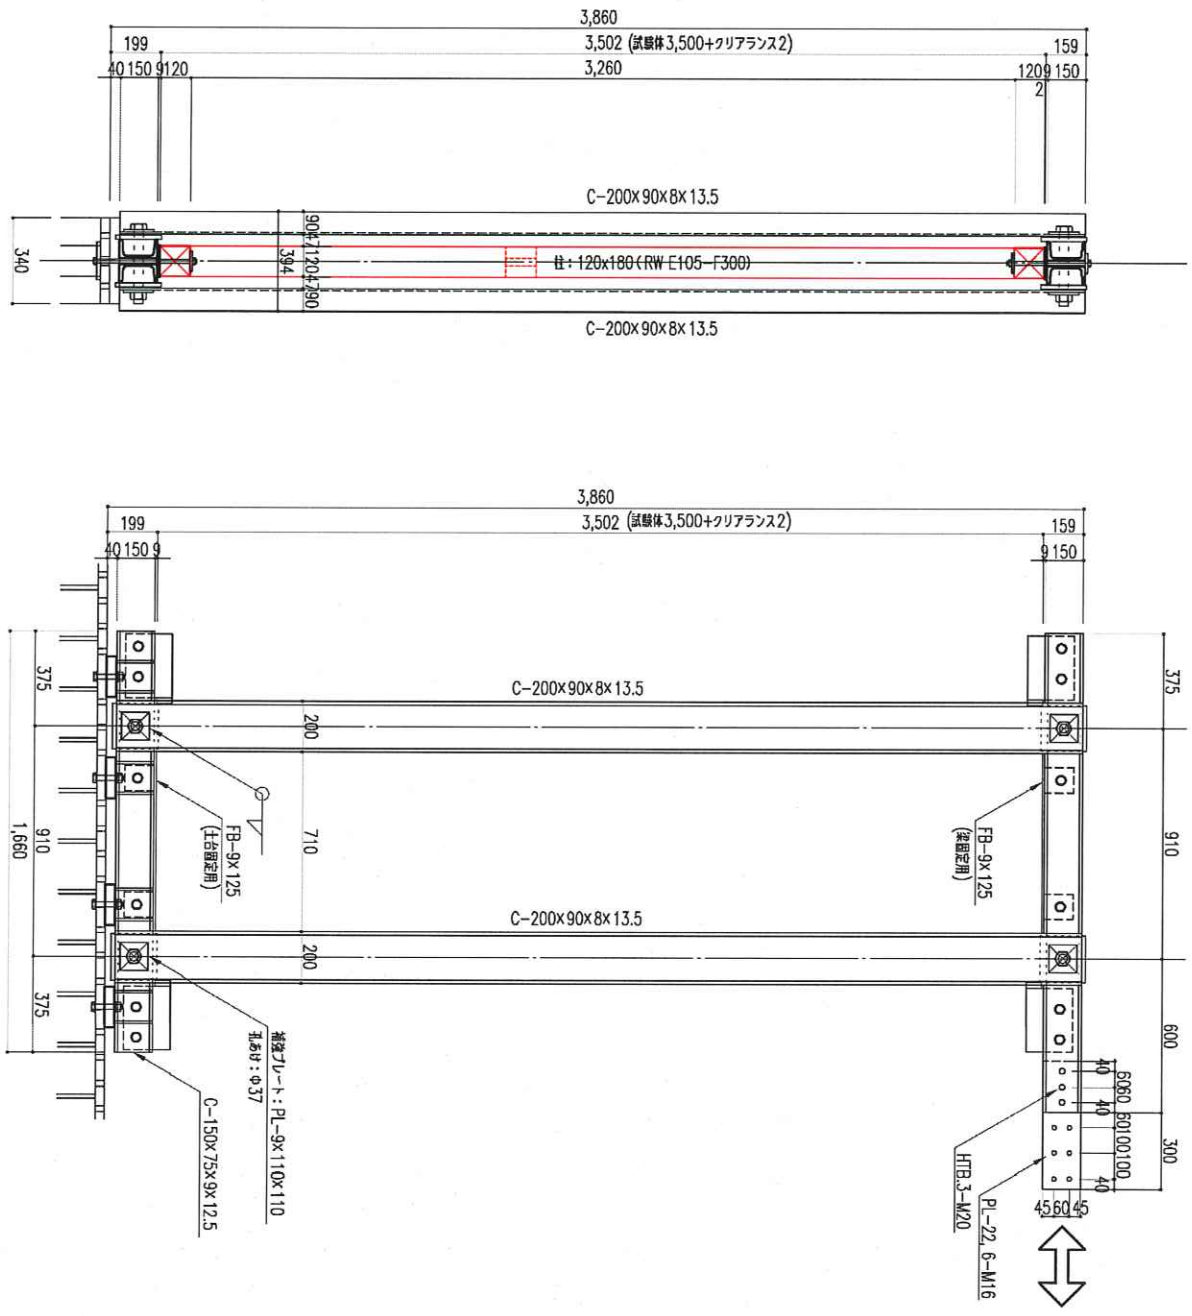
試験法 B 試験体図 (鉄骨治具) (単位: mm)
